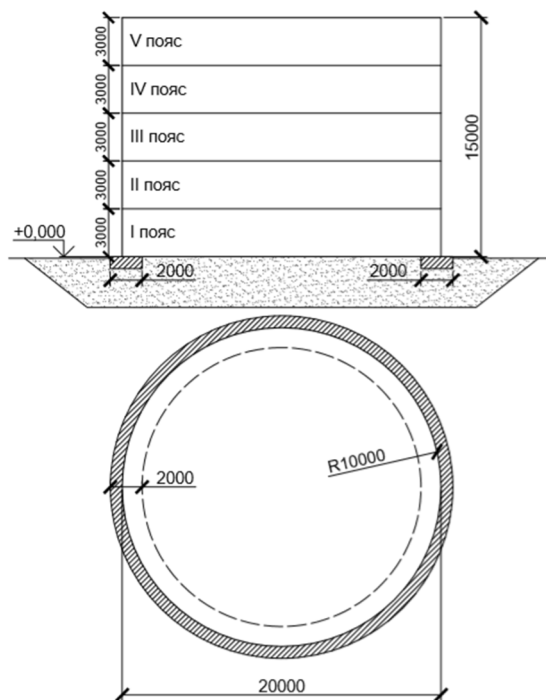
Сталевий циліндричний резервуар об'ємом 4500 м²
